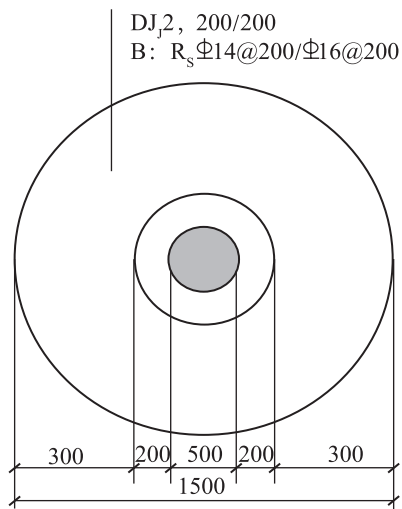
圆形独立基础放射状配筋平面示意图 图 2-24 圆形独立基础放射状钢筋示意图
